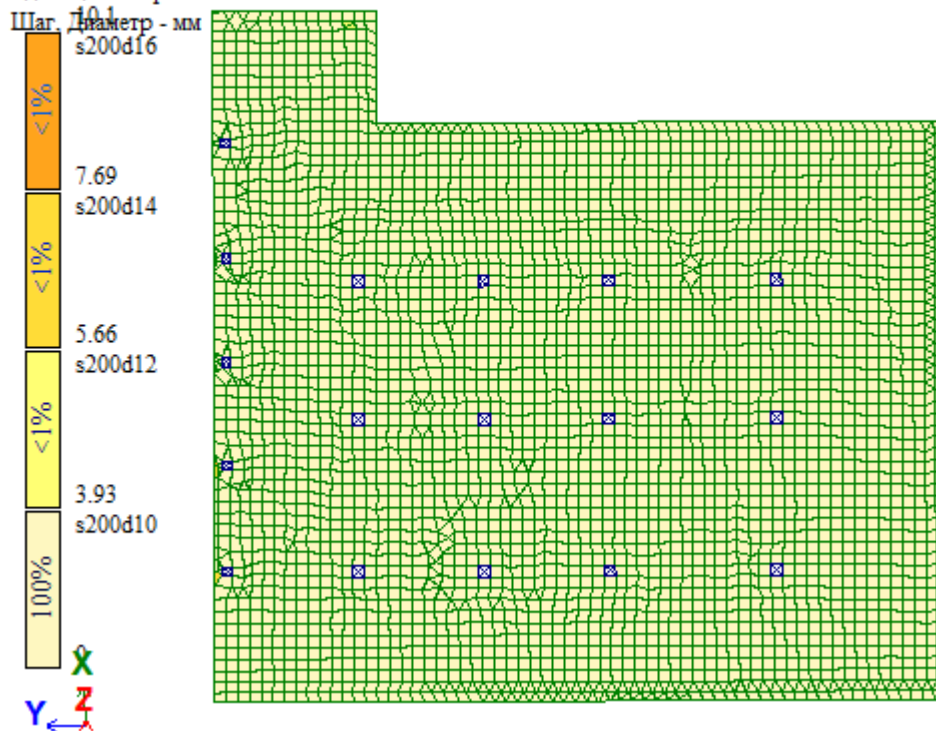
Схема армирования верха плит по оси ОУ
